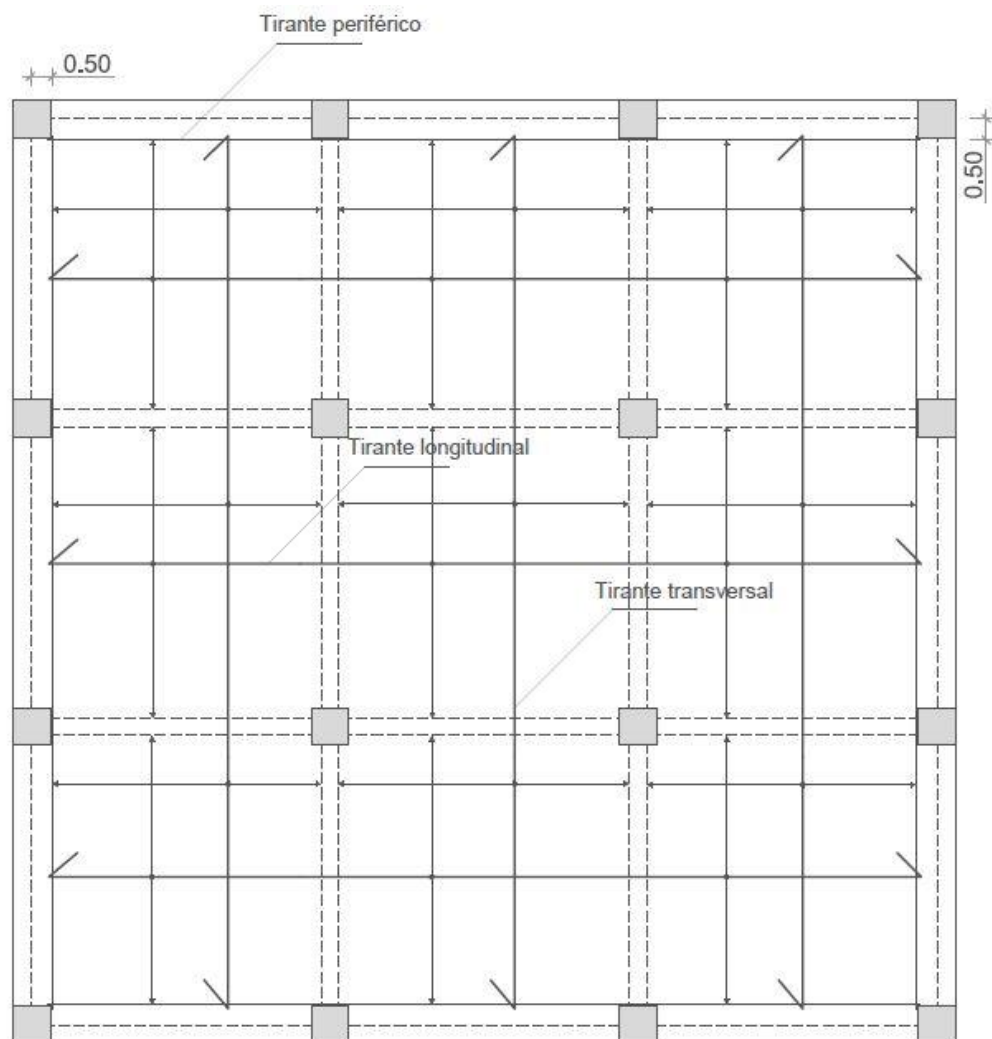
Pormenorização de laje de acordo com o UFC para tirantes internos
